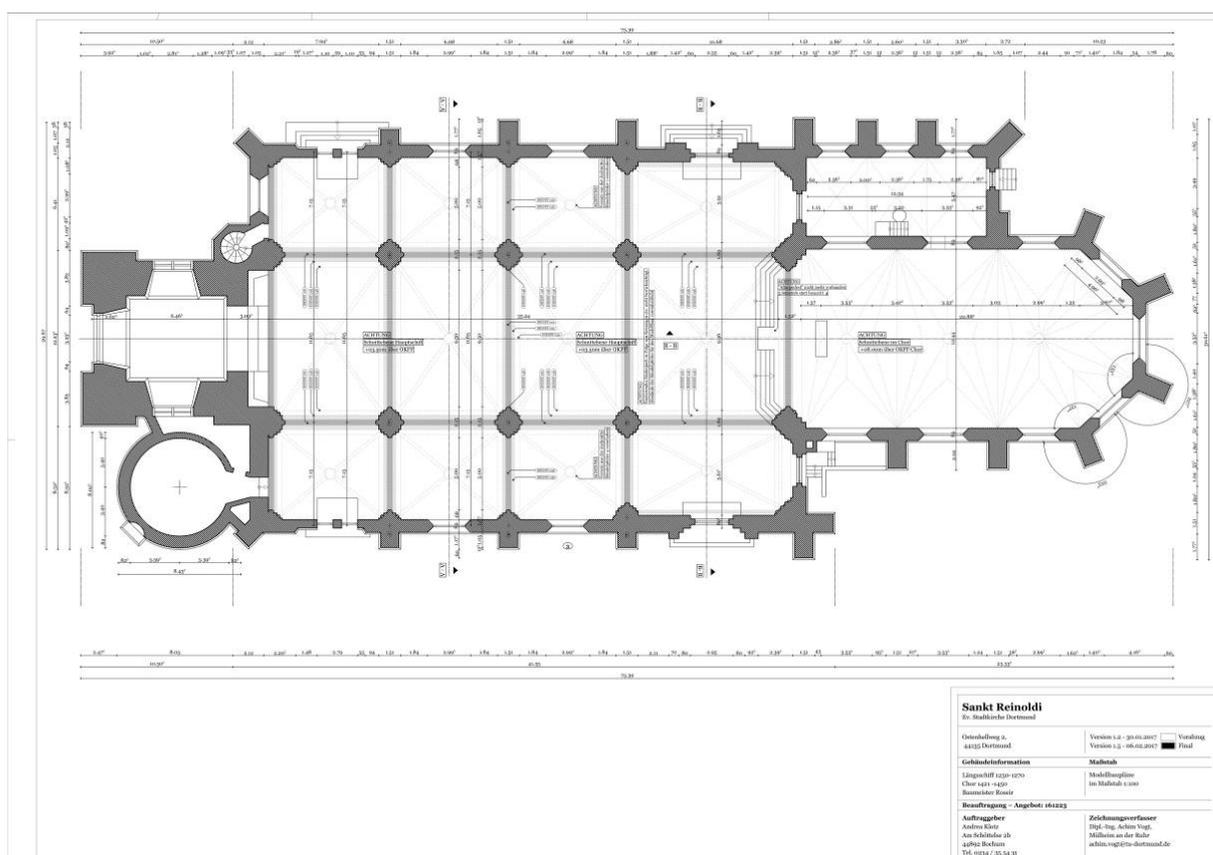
Digitaler Plan für *Modell-Ensemble*, Grundriss, Maßstab 1:100, erstellt durch Achim Vogt, PDF-Datei (84,1 x 59,4 cm). (© ak)
